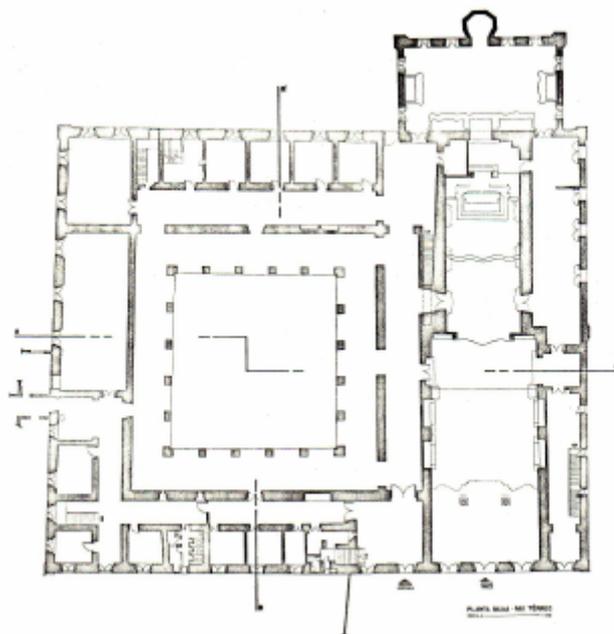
Planta Baixa do Pavimento Térreo do Mosteiro de São Bento de Olinda - PE
